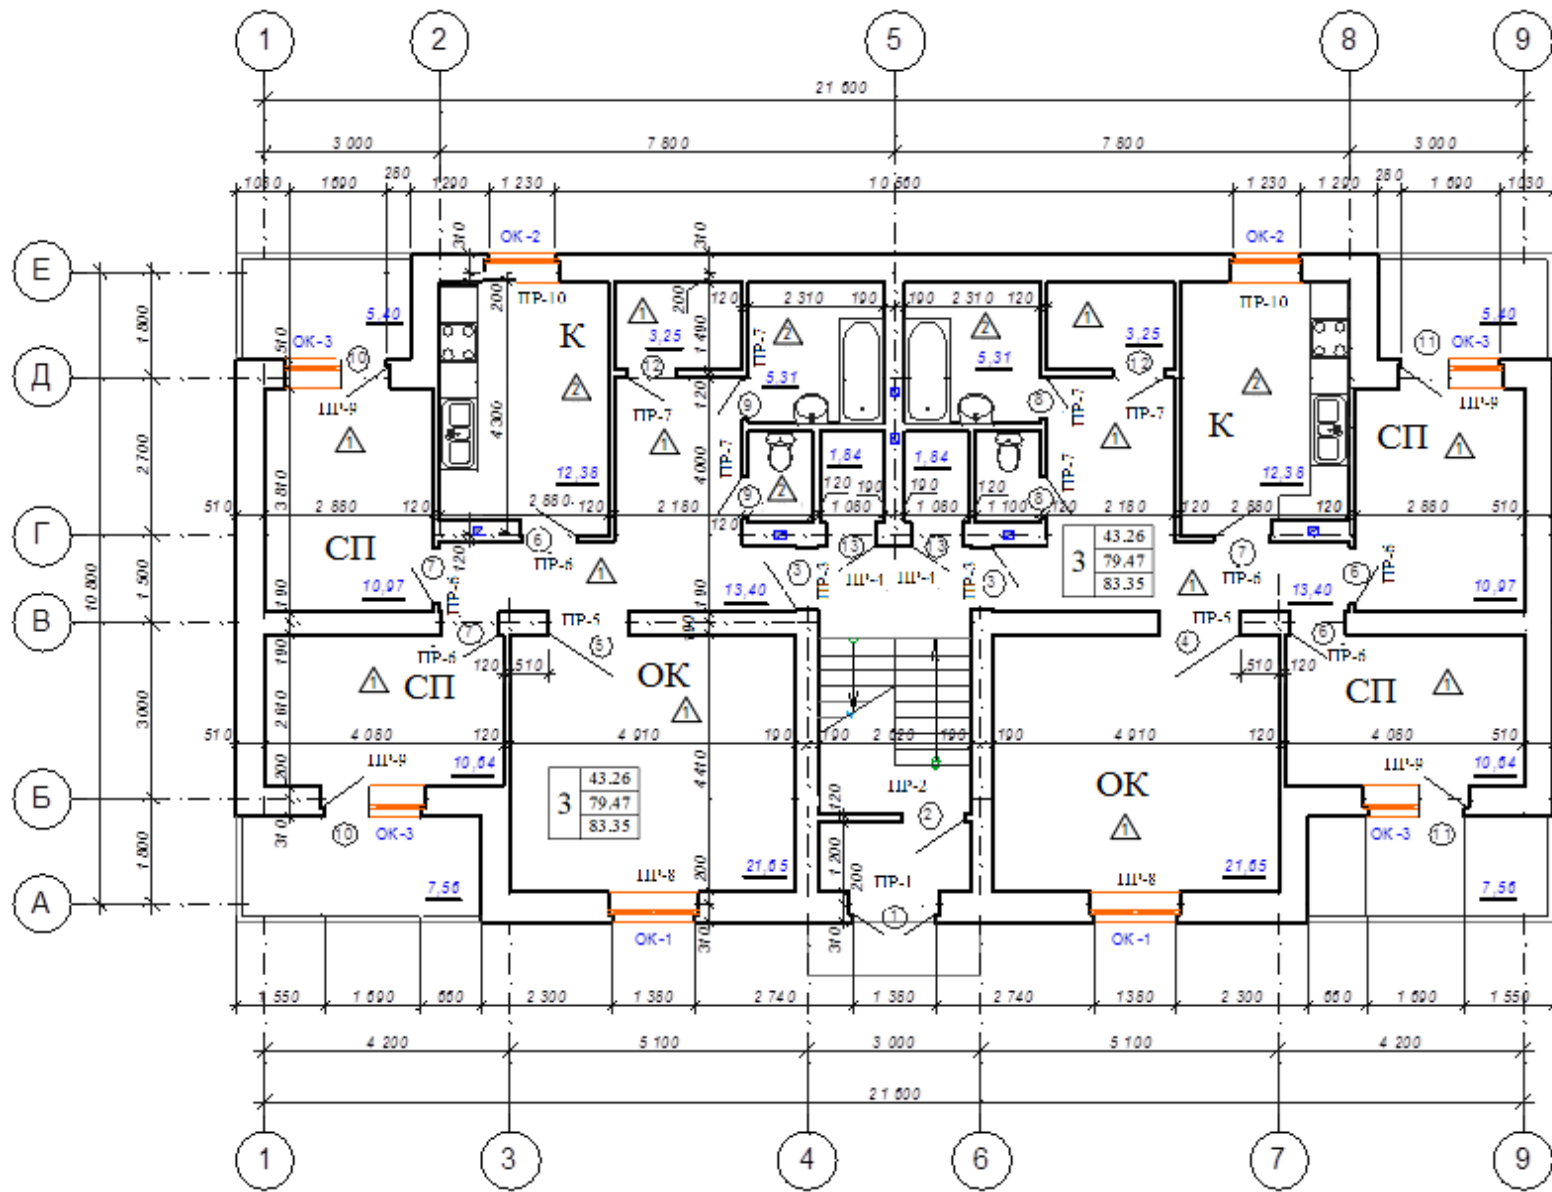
Пример оформления плана 1-го этажа жилого дома со стенами из мелкоразмерных элементов
